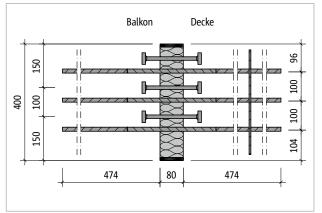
Schöck Isokorb® T Typ QP-V9: Produktgrundriss
